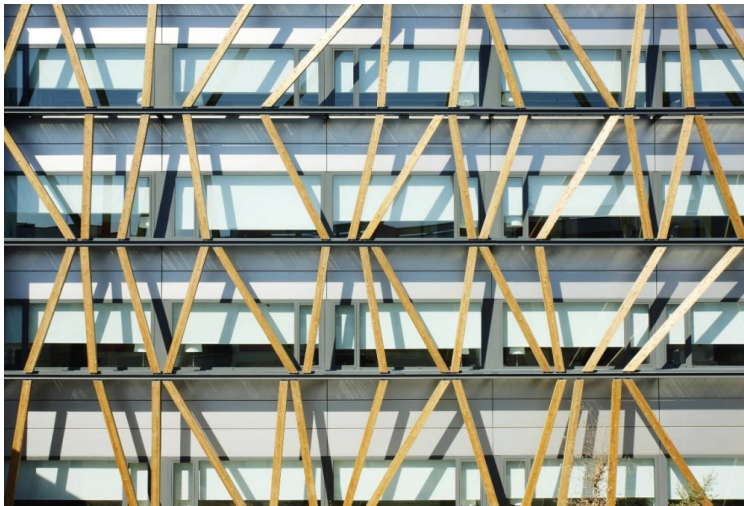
Fachada sur e Ilustración 43 – Detalle de fachada (Fuente: Archdaily)
